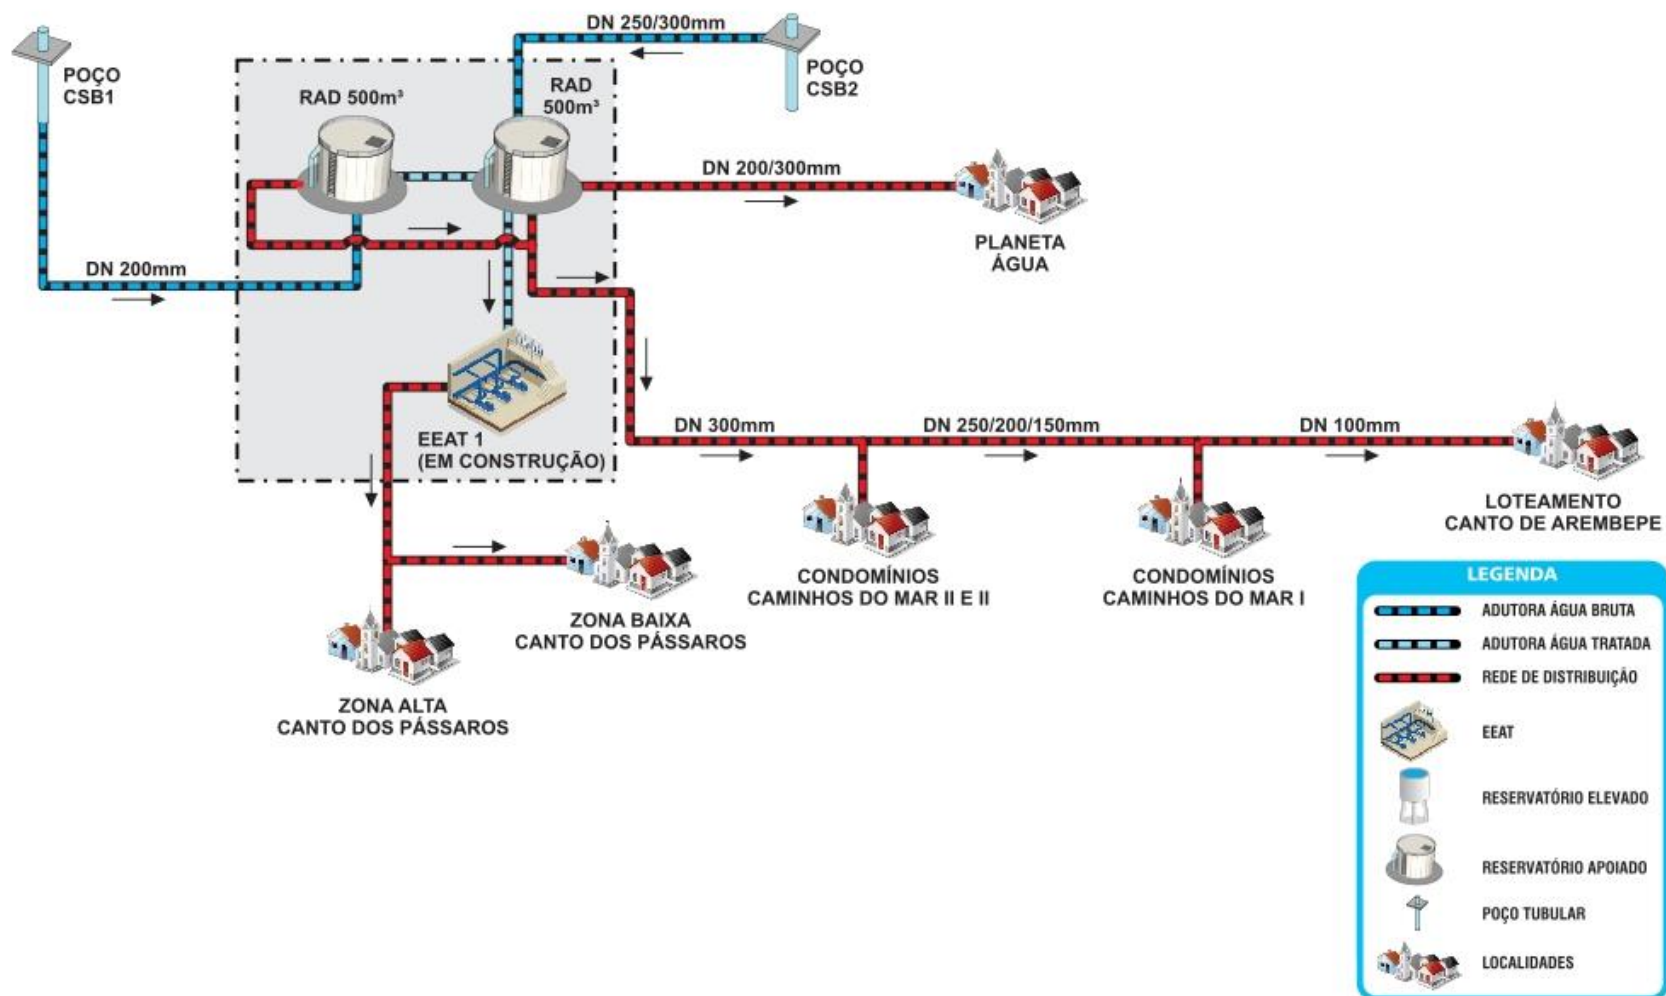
Croqui esquemático do SAA Canto dos Pássaros
